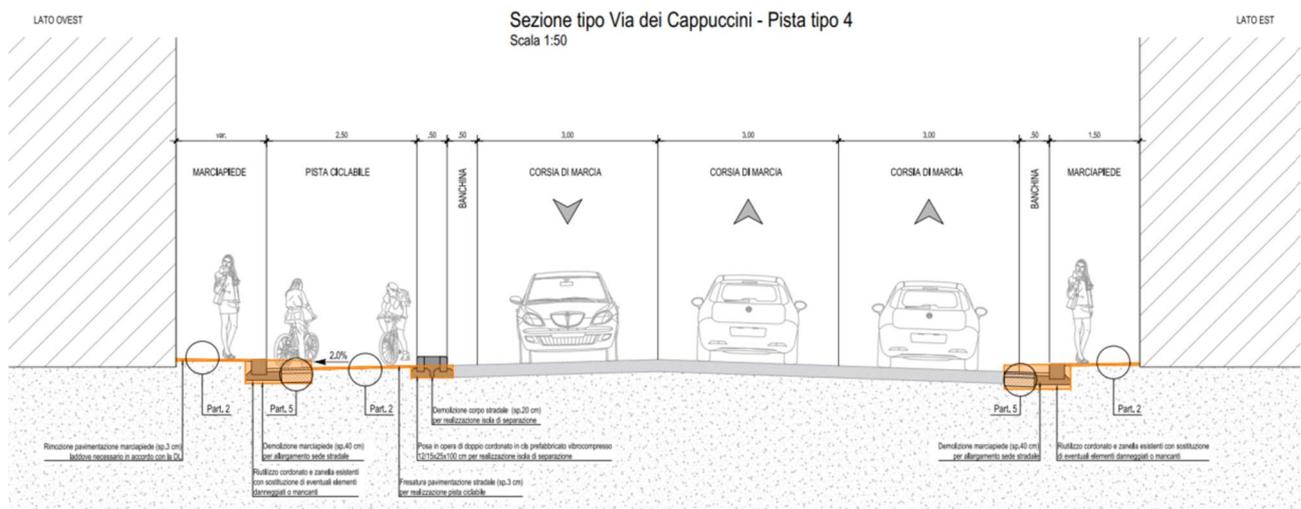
Sezione tipo Via dei Cappuccini – primo tratto
